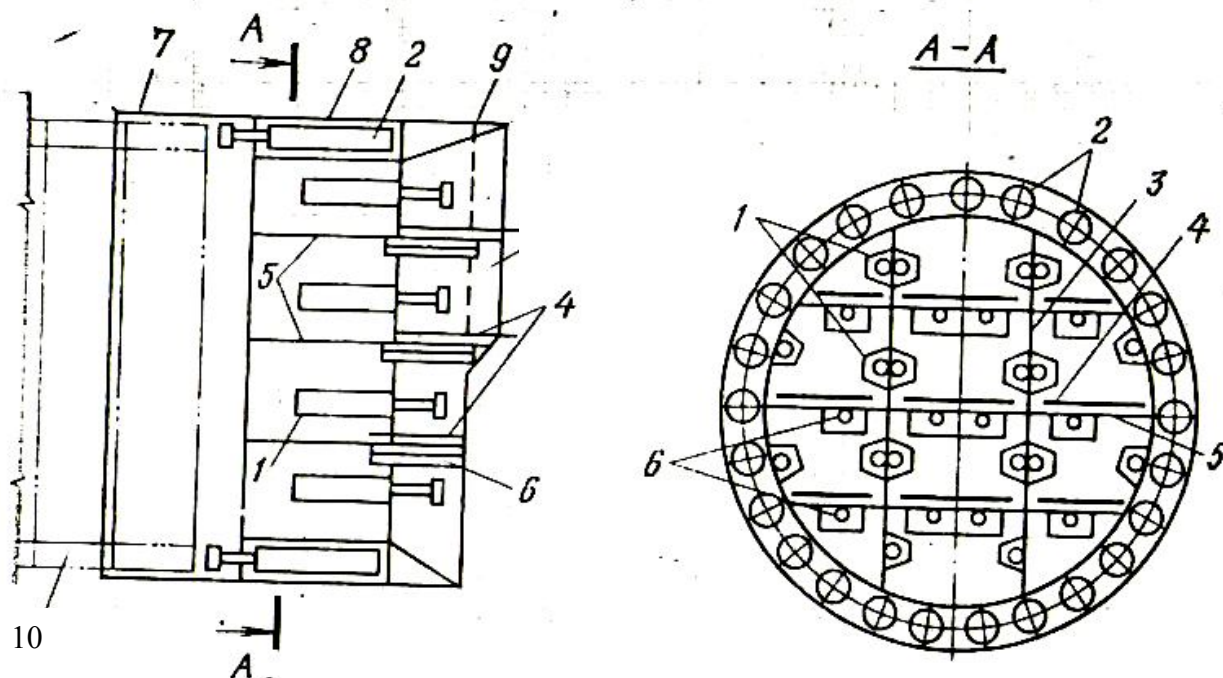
Конструкция проходческого щита: 1 – забойные домкраты; 2 – щитовые домкраты; 3 – вертикальные перегородки; 4 – выдвижные платформы; 5 – горизонтальные перегородки; 6 – платформенные домкраты; 7 – хвостовая оболочка; 8 – опорное кольцо; 9 – ножевое кольцо; 10 – обделка
